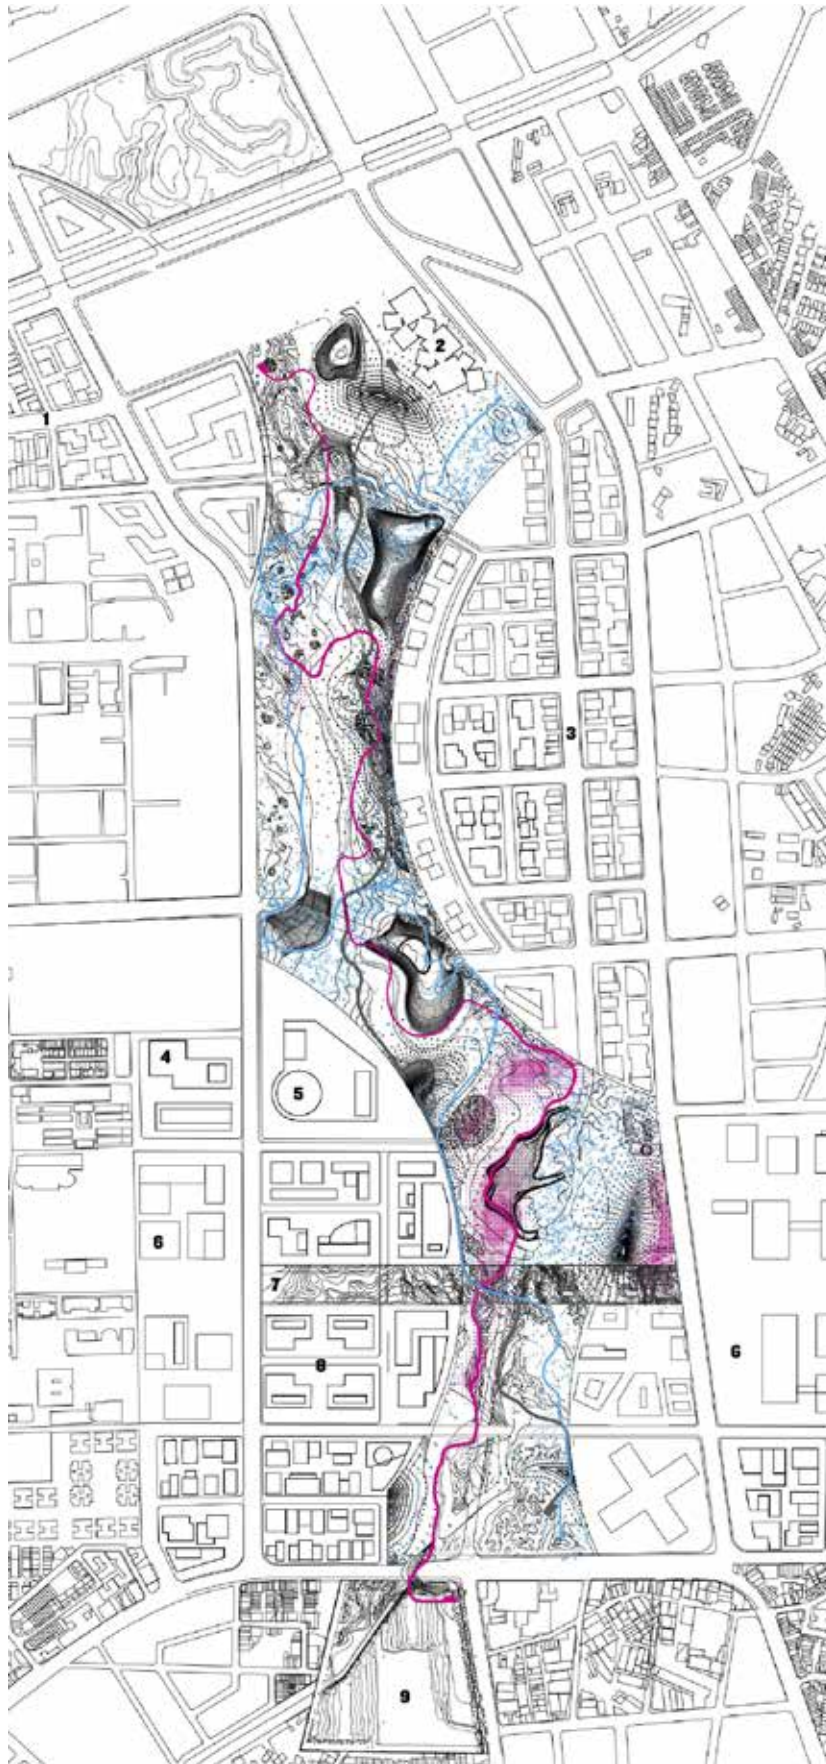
Philippe Rahm, Jade Eco Park, Taichung, 2020. Planimetria del parco con indicazione delle aree di maggiormente soggette a riscaldamento, umidità e inquinamento, rilevate tramite interpolazione di sensori.
